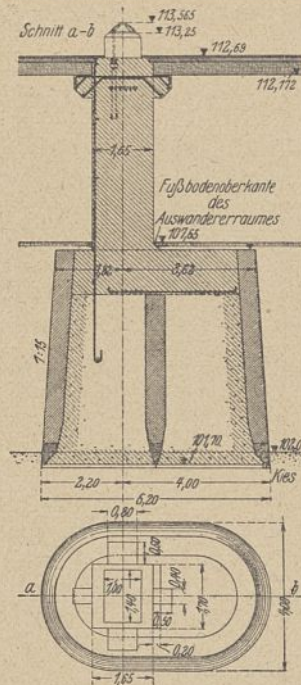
Gründungkörper B3, Schnitt und Grundriß. M. 1:200.
